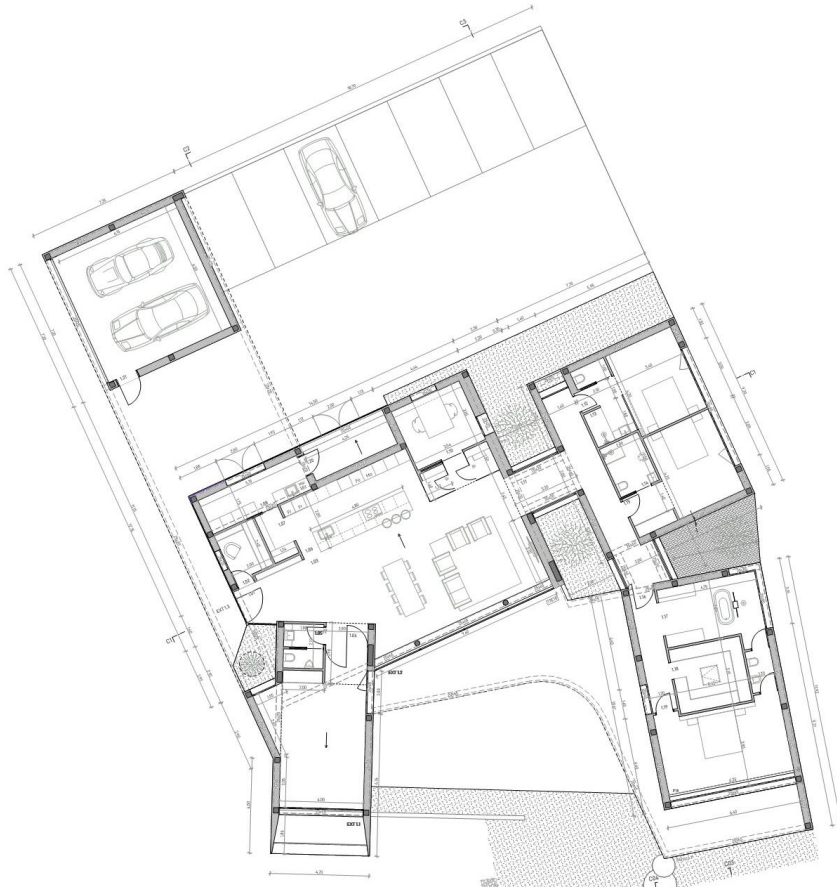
Planta Piso 1, Habitação Corredoura. Fonte: FSA.
